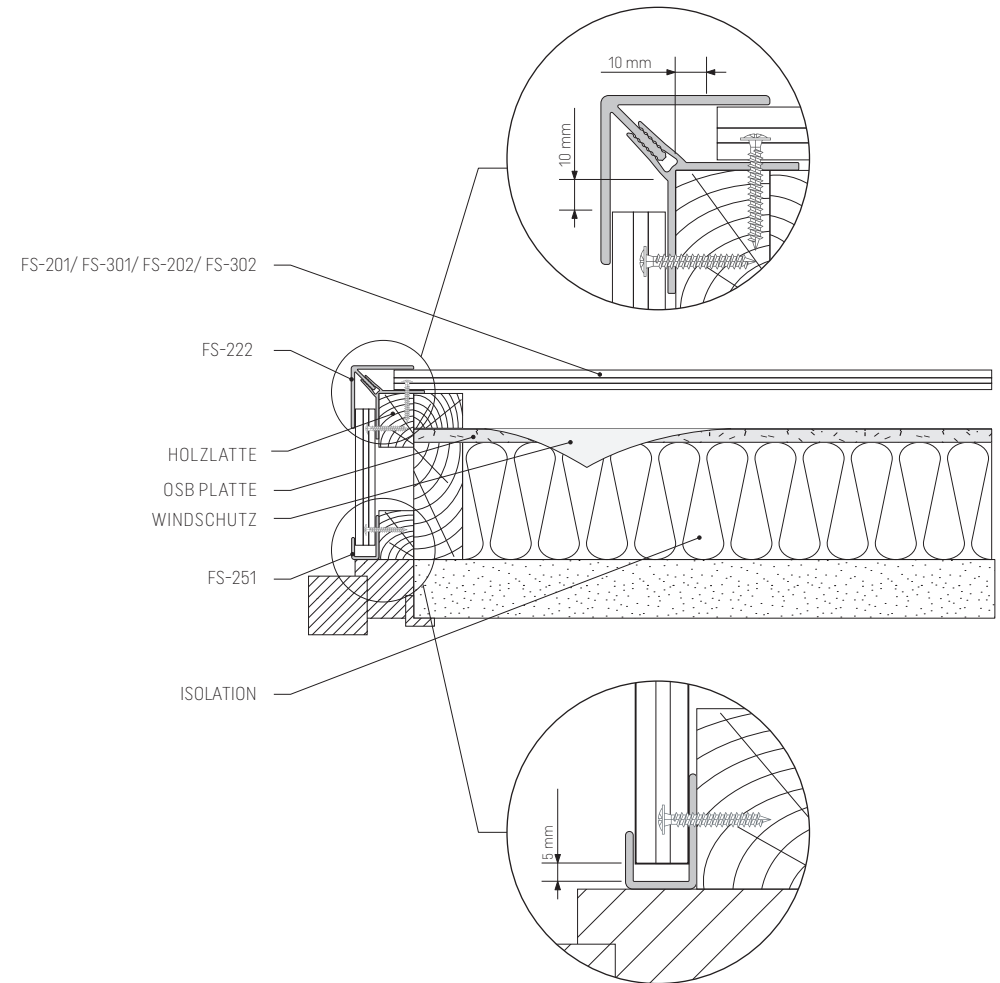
KERRAFRONT Detail, Ecke, Holzelemente an der Gerüstkonstruktion - horizontaler Schnitt
